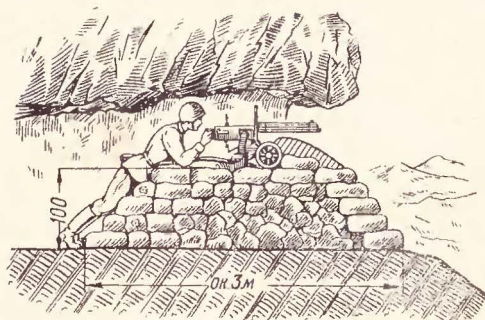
Приспособление пещеры для стрельбы из станкового пулемета
